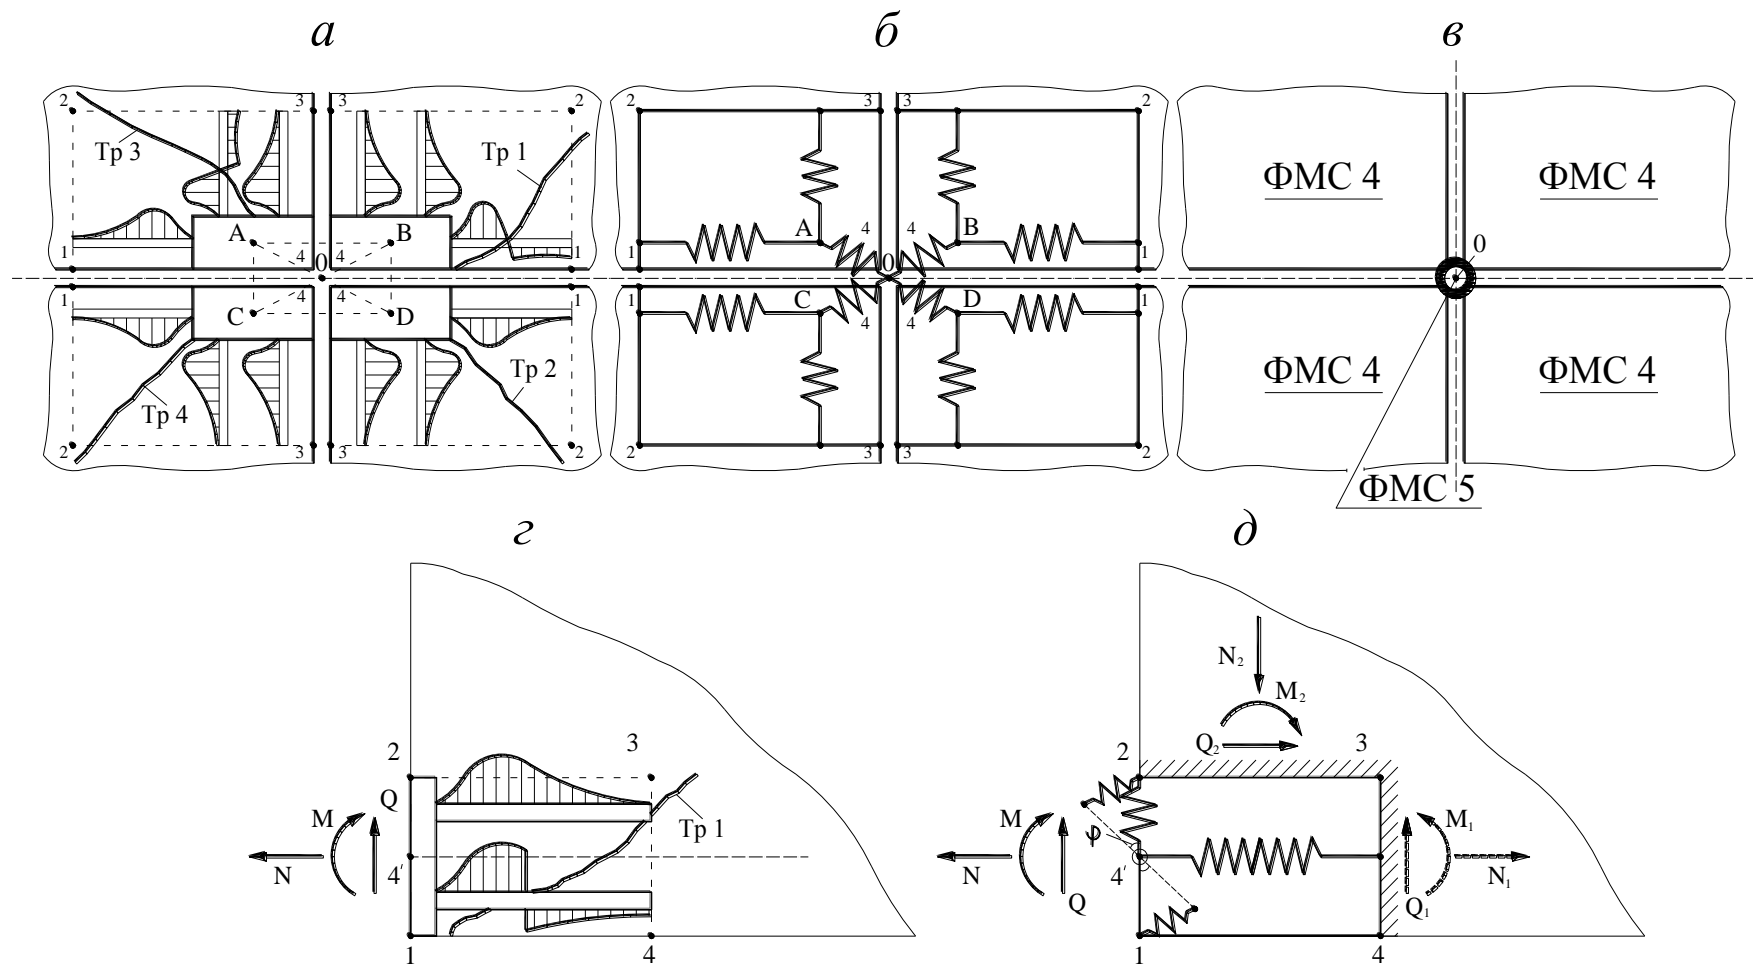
Модели закладных деталей железобетонных конструкций:
